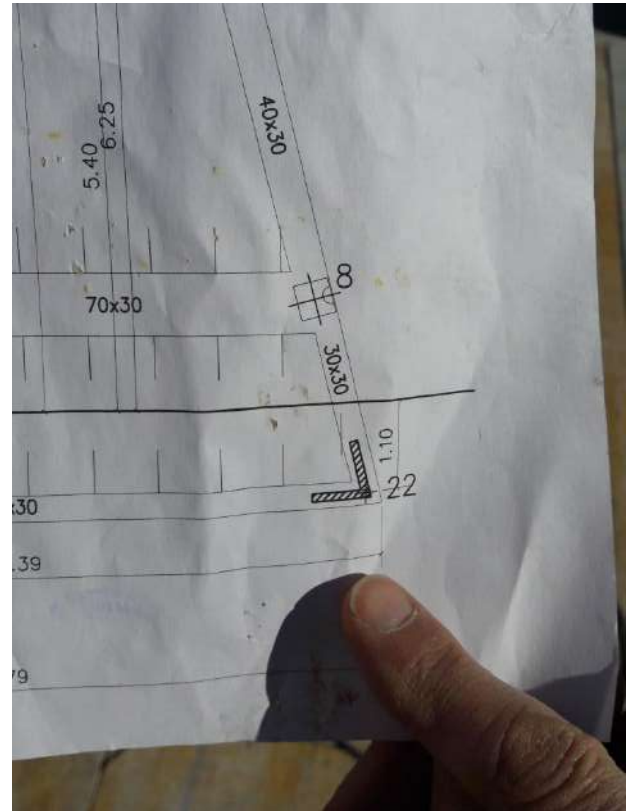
Anclaje estructura metálica forjado de hormigón armado mal ejecutado
